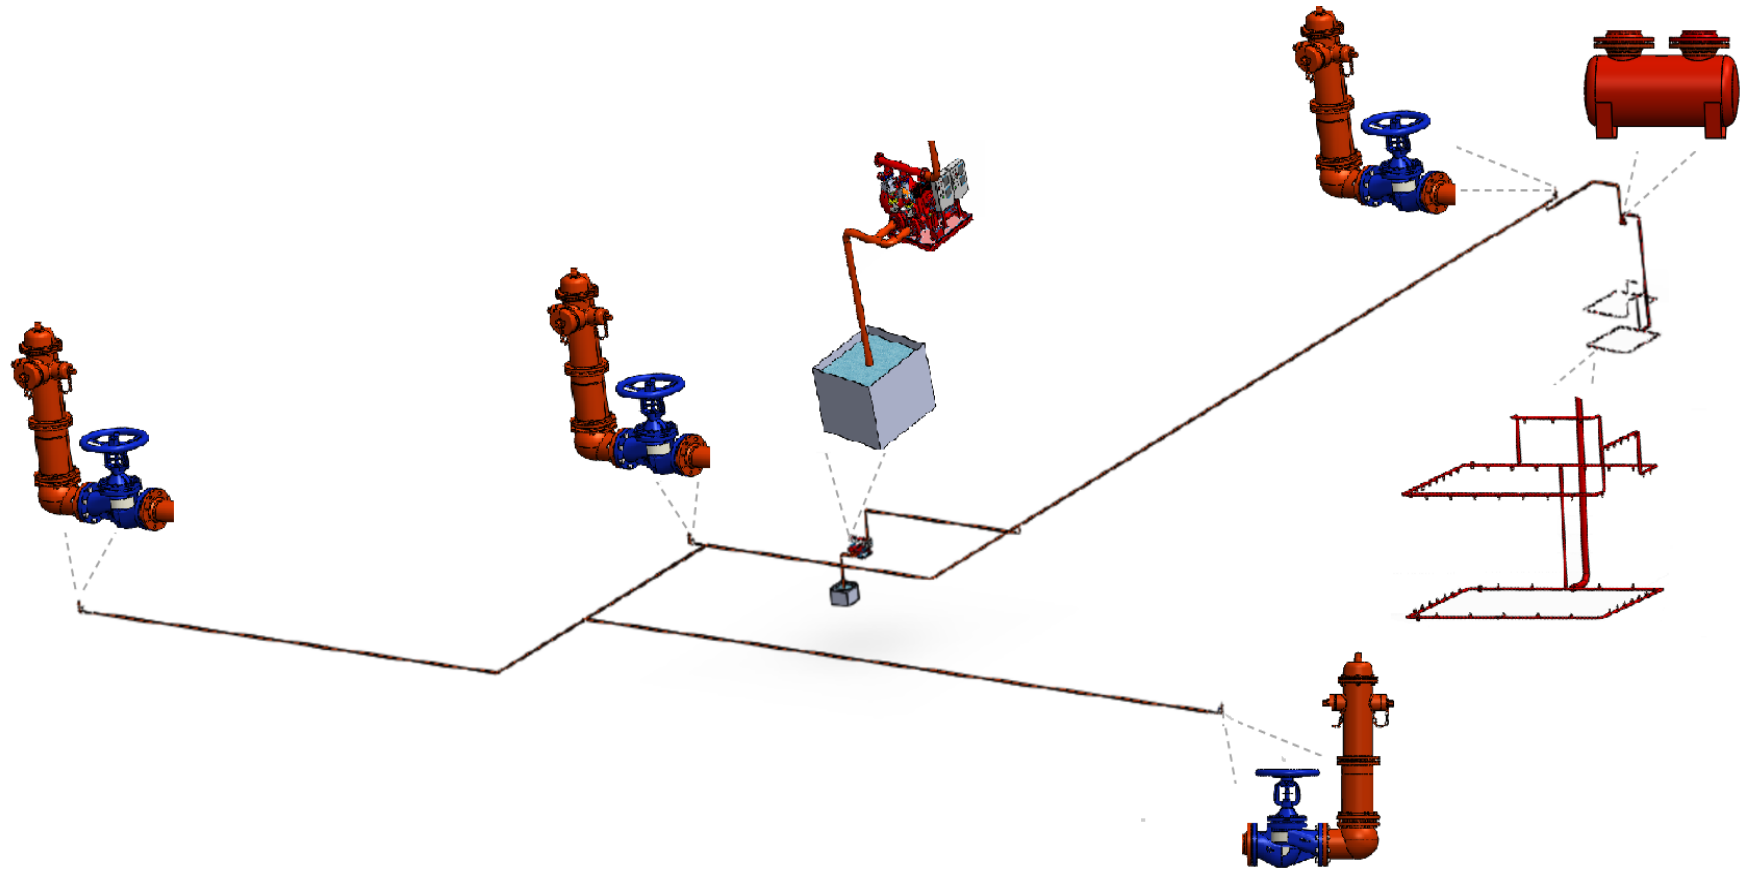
Anexo IV - Desenho técnico RIA+SAEI
